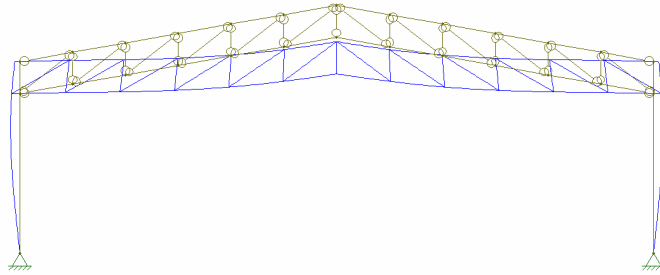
Deformada da estrutura devido a sobrecarga de cobertura.
